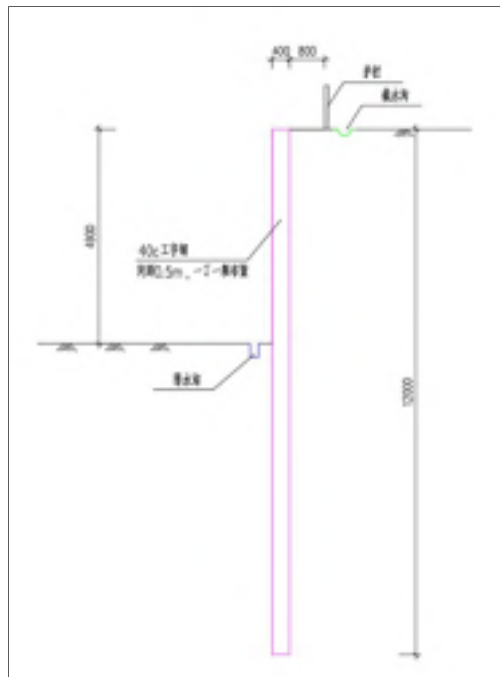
基坑开挖剖面图（以开挖 4.90m 为例，单位：mm）
